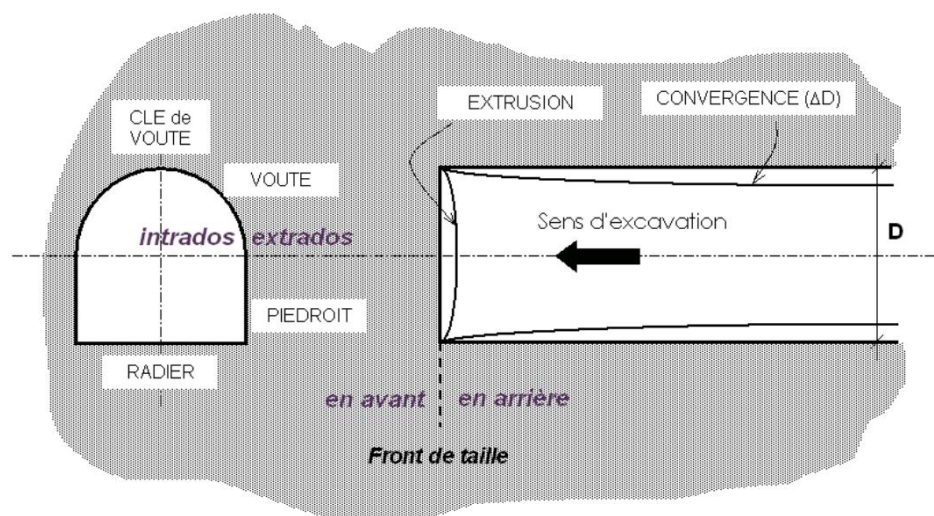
Coupe transversale et longitudinale d'un tunnel au voisinage du front de taille (Levasseur., 2007).
